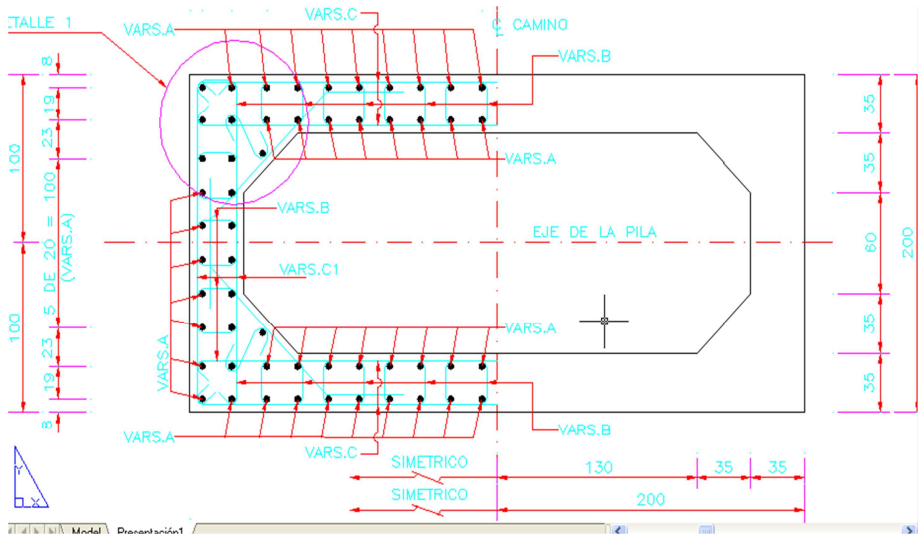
Detalle del armado del refuerzo transversal
